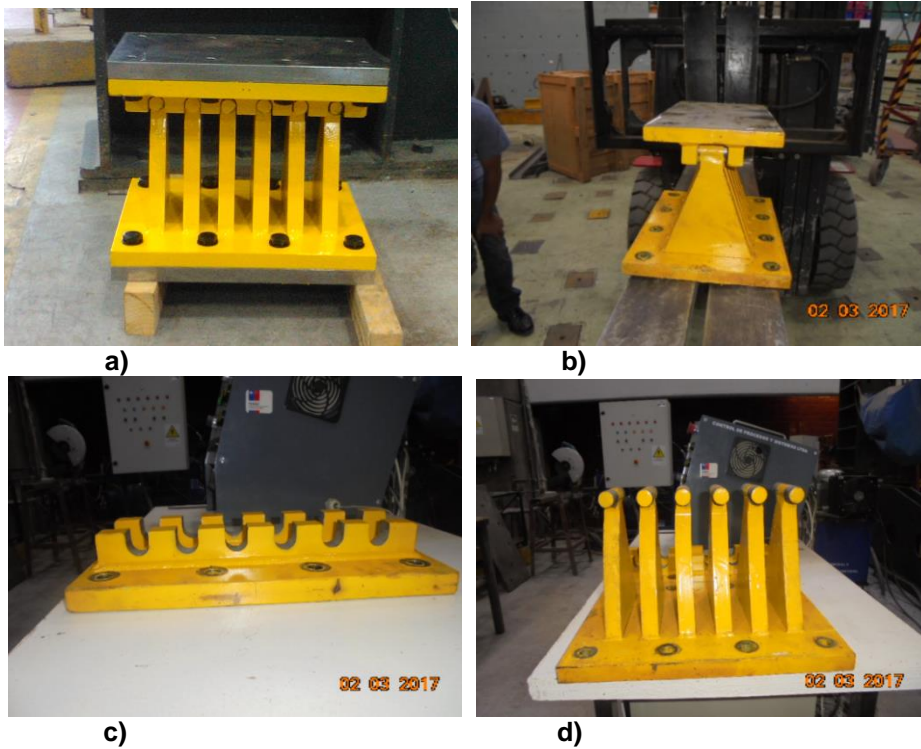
Descripción de disipador TADAS; a) Vista de disipador con las placas exteriores; b) Disipador TADAS sin las placas exteriores; c) Placa de Corte de disipador TADAS; d) Placa de Flexión de Disipador TADAS.
